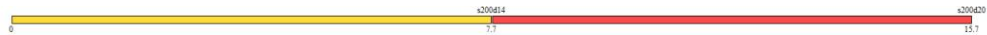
Повздожня арматура верхнього поясу
